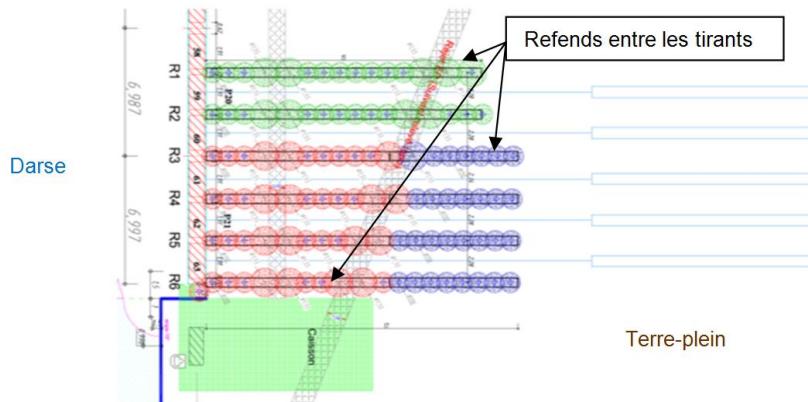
Renforcement par panneaux de jet grouting de la zone décomprimée
